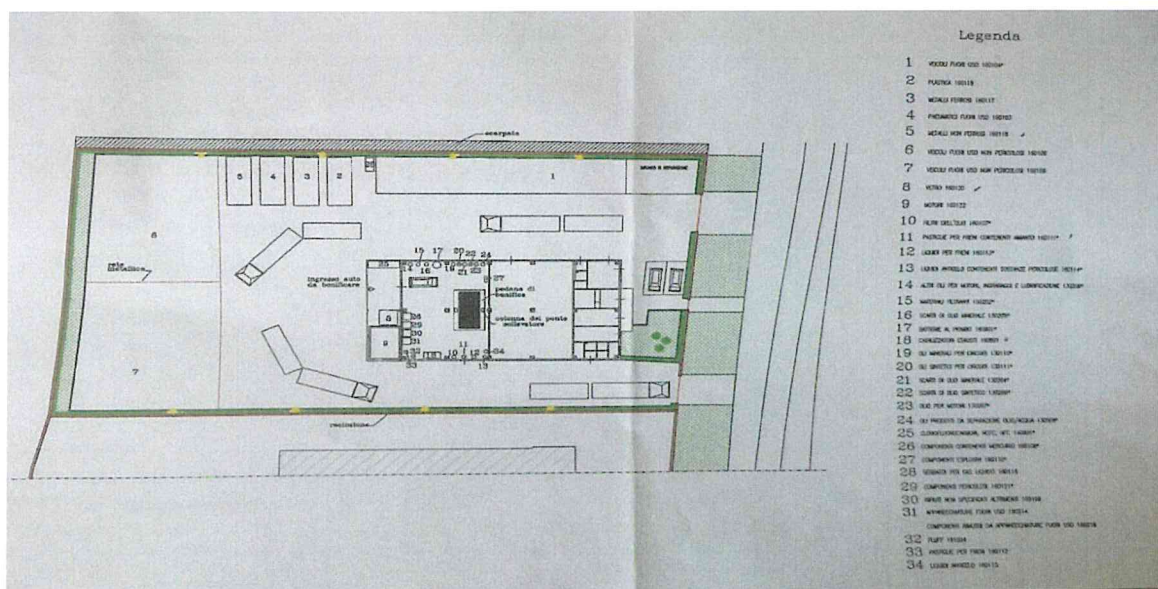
Lay-out impianto Autodemolizione La Moderna s.r.l.
